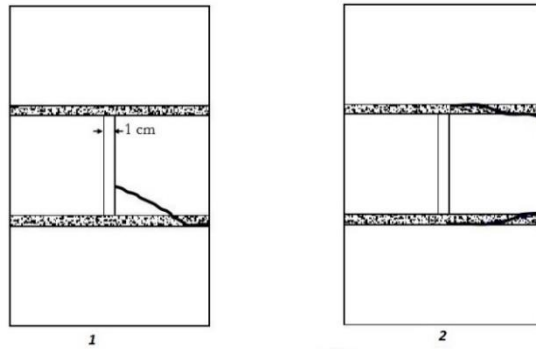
Schéma de Fissuration, [Lafuente, 1990]
